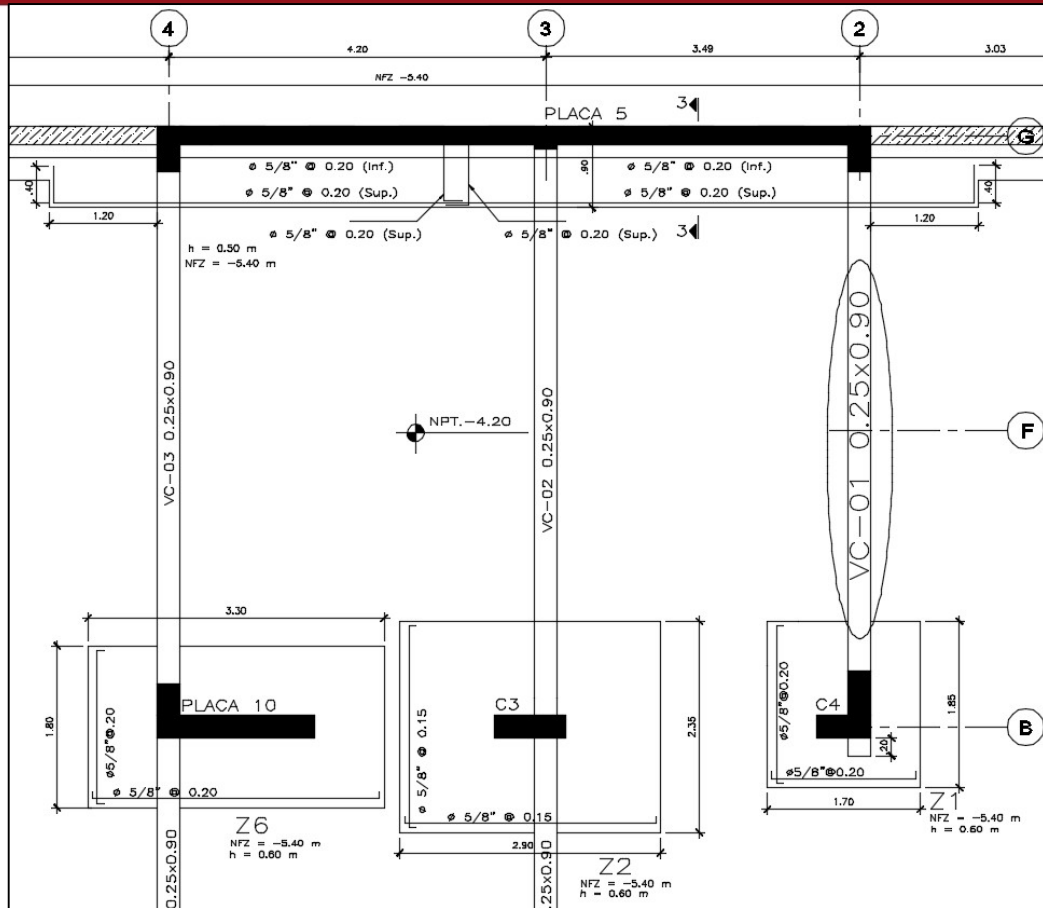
Diseño final zapata conectada de la Placa PL-05
